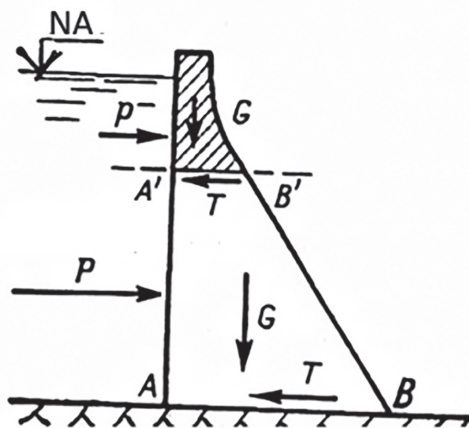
Esquema de la sección transversal de una presa a gravedad de hormigón cimentada en roca.
